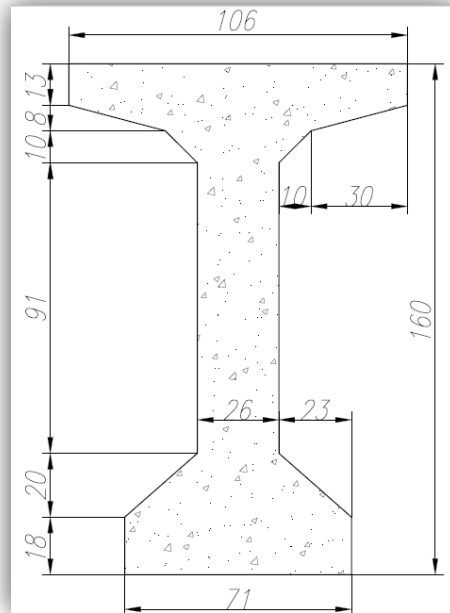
Viga tipo AASTHO V, dimensiones sección transversal
